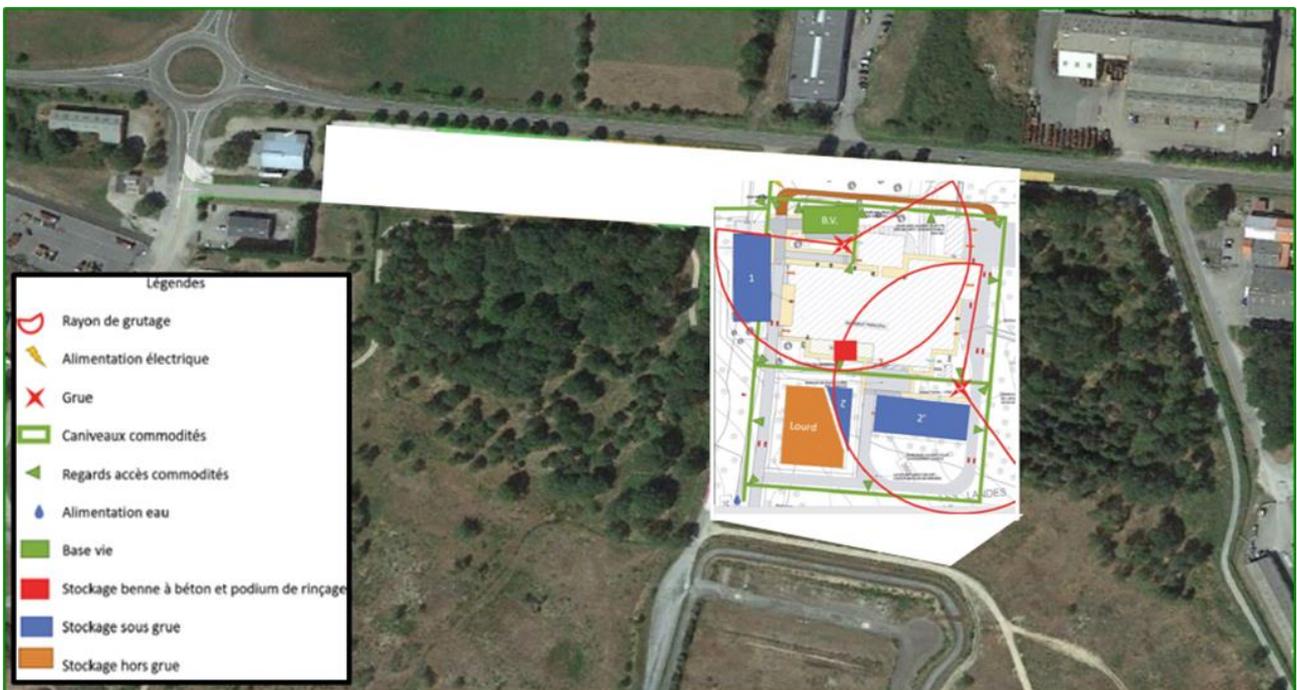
Exemple d'implantation du chantier de l'installation ATEF
